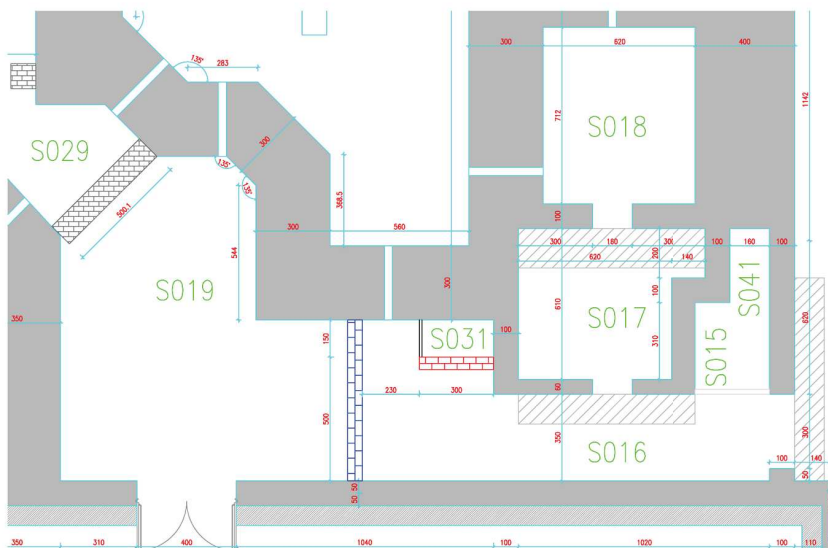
Planimetria del piano -1 dell'edificio SPES.
